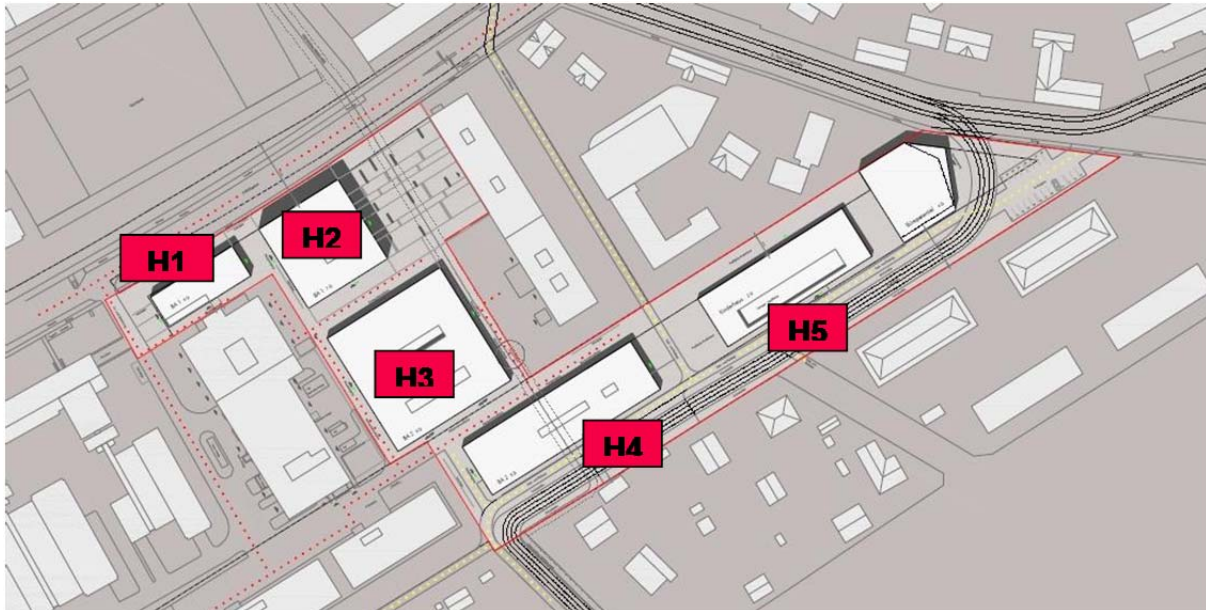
Grundrissplan des Produktionstechnikzentrum Inffeldgasse
